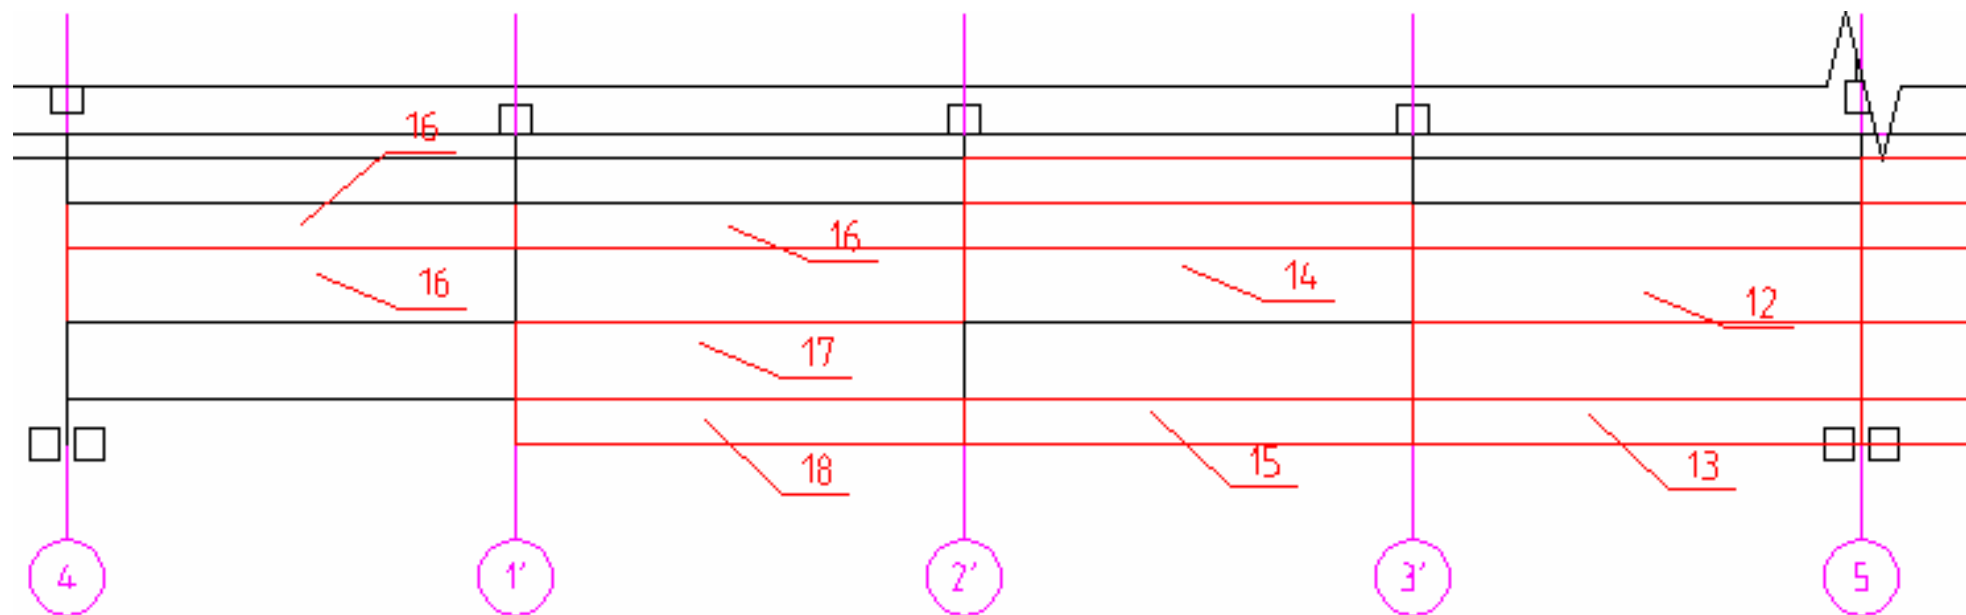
Карта дефектов плит перекрытия пандуса с осях «4–5/А».
